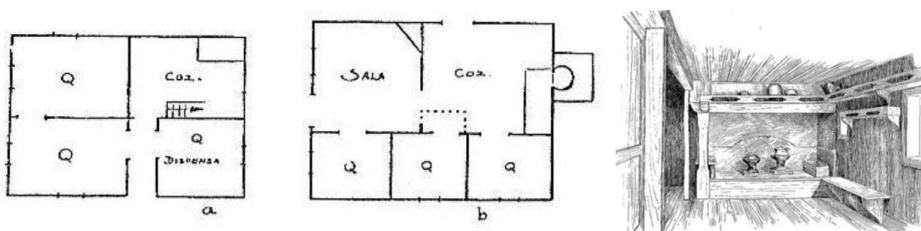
Plantas e vista de cozinha de casa abastada, Palheiros de Mira (fonte: Oliveira & Galhano (1964))
